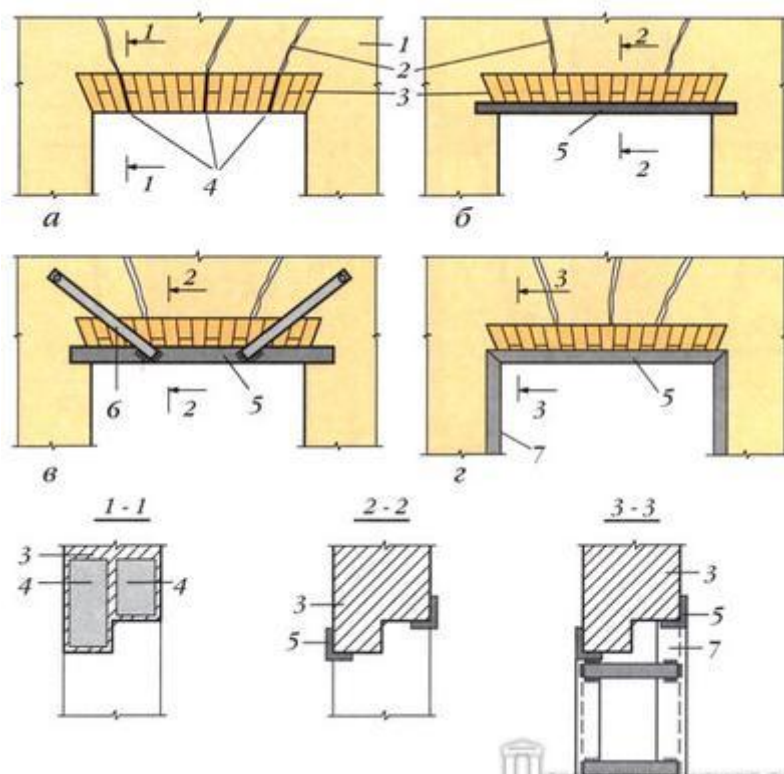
Усиление кирпичных перемычек: а - расклинивание трещин стальными пластинами; б, в - стальными уголками при небольшом (б) и длинном (в) пролетах; г - стальными уголками, соединенными со стальной обоймой простенков; 1 - кирпичная стена; 2 - трещина; 3 - перемычка; 4 - стальные пластины-клинья; 5 - стальной уголок; 6 - тяжи из полосовой стали; 7 - стальная обойма простенка.
